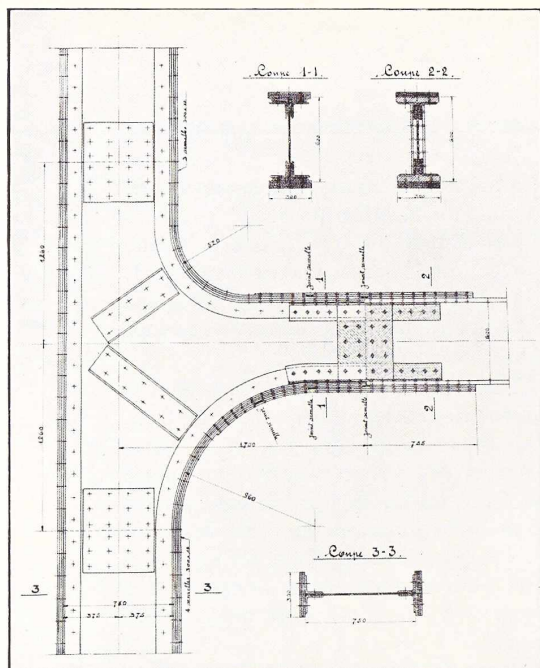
Vue en élévation d'un nœud d'assemblage des poutres aux montants.
